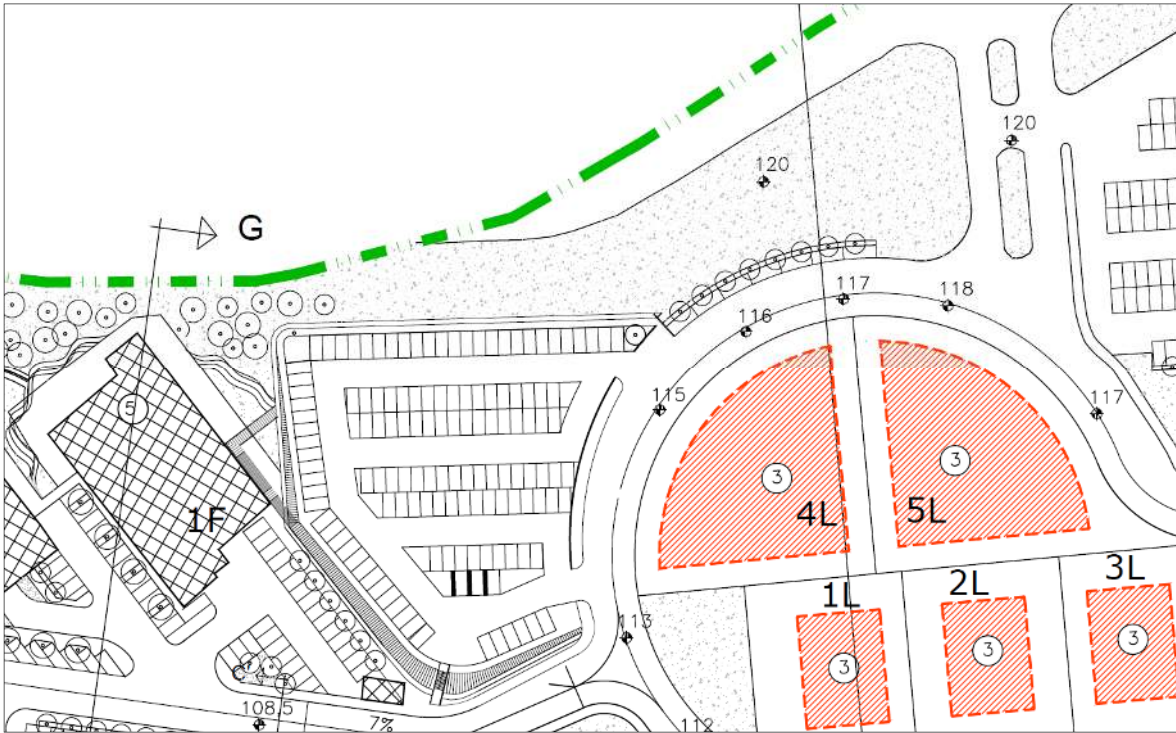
Confronto planimetrico del PP Zona D2 vigente (immagine a pag. 7) e proposta di variante (immagine a pag. 8).
